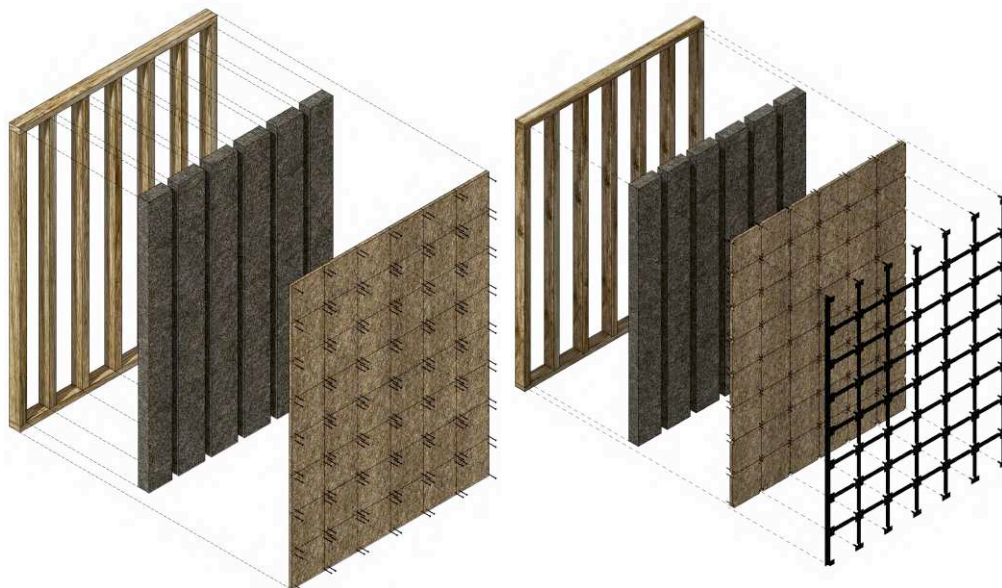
Secuencia constructiva tabiquería liviana. Fuente: autor
